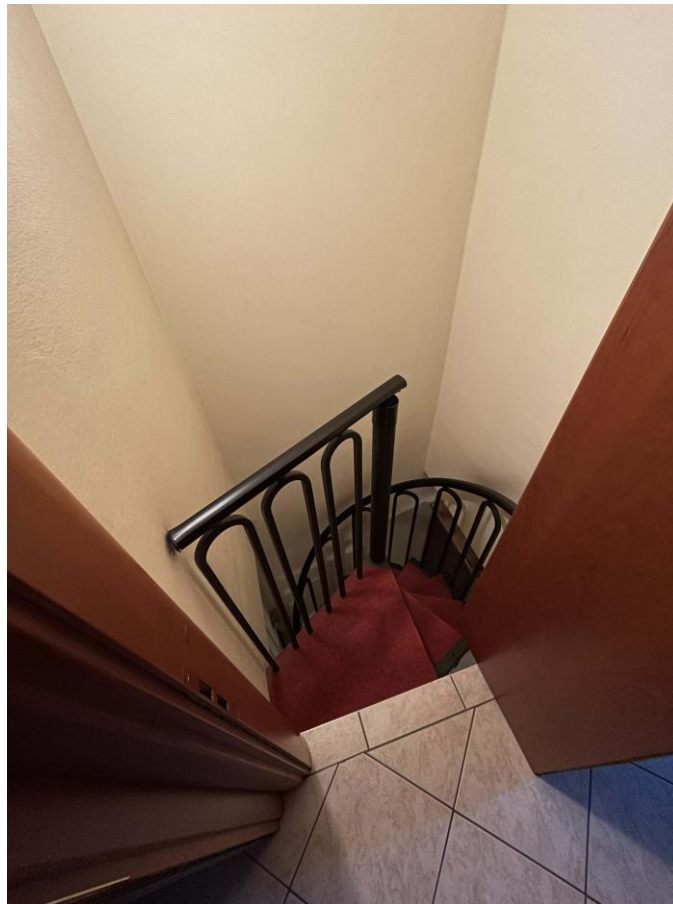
Appartamento – Piano I° – Scala d'accesso garage
